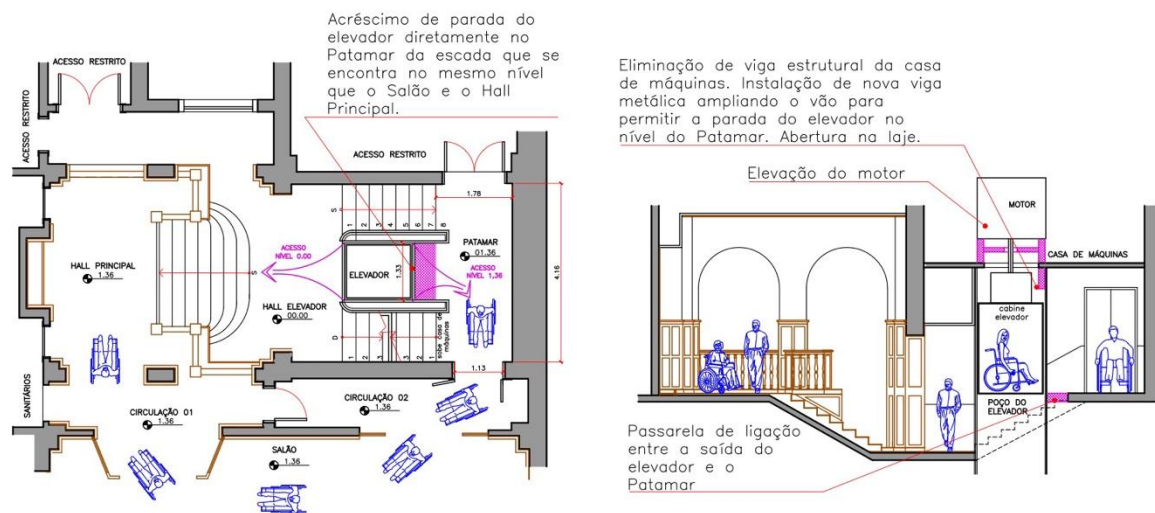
planta e corte esquemático sem escala da proposta de acréscimo de parada de elevador.
